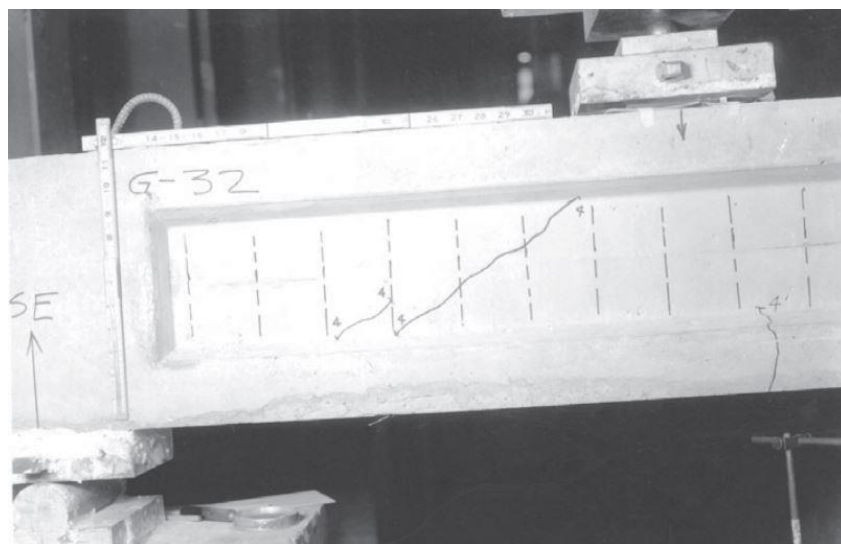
Foto av opprisset armert betongbjelke (14)
